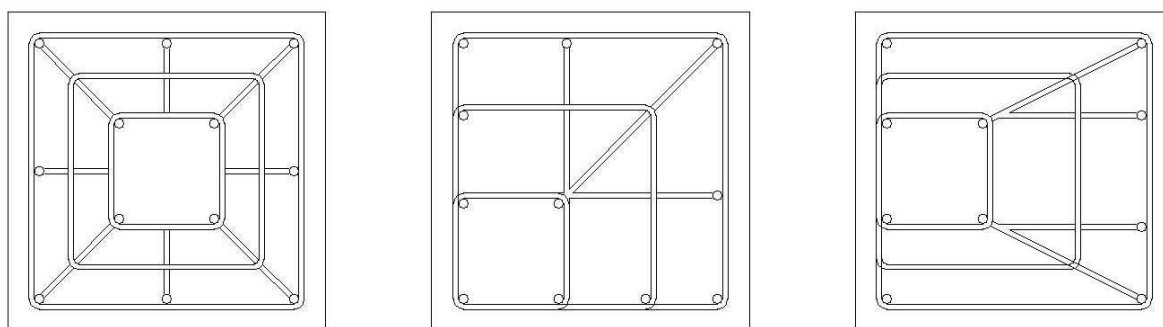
a. Esquema col·locació armats recrescuts segon excentricitat del pilar
